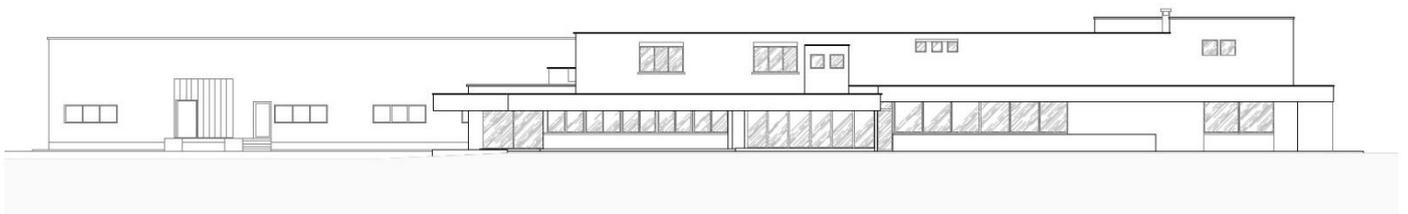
Prospetto Est. Scala 1:500. Fonte: Bottega Veneta.
